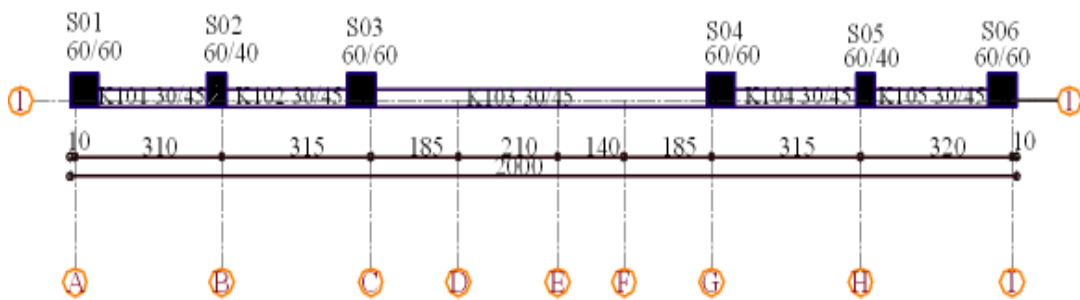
Perdelerin kaldırılmasından sonra oluşturulan salt kolonlu yapının kalıp planı
